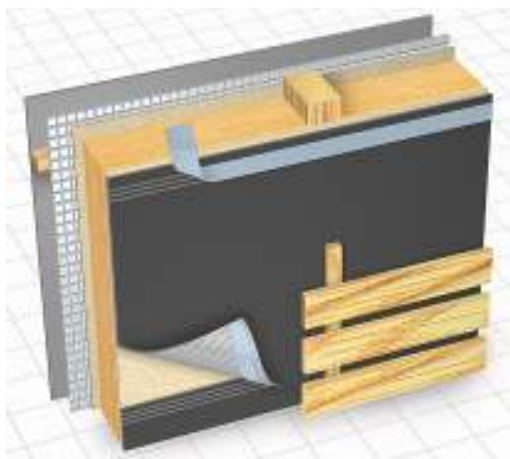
Disposição das membranas da DELTA e ripas em parede exterior (Fonte: Dorken, 2013).
